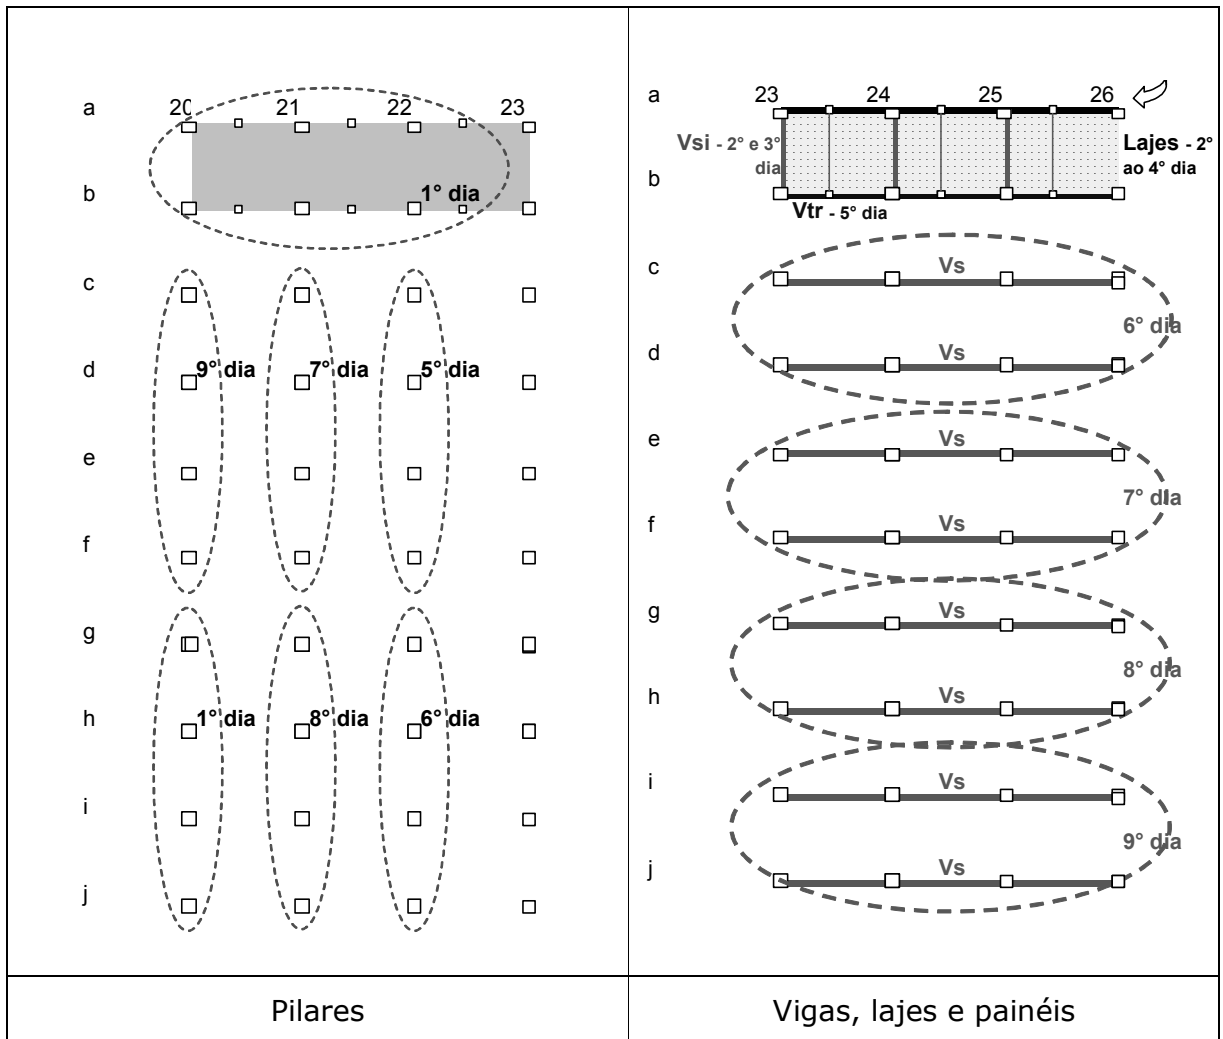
Plano de seqüenciamento dos pilares, vigas e painéis – Etapa 3
